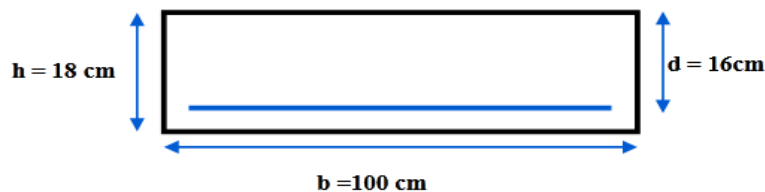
11 : Section transversale pour la paillasse de l'escalier
